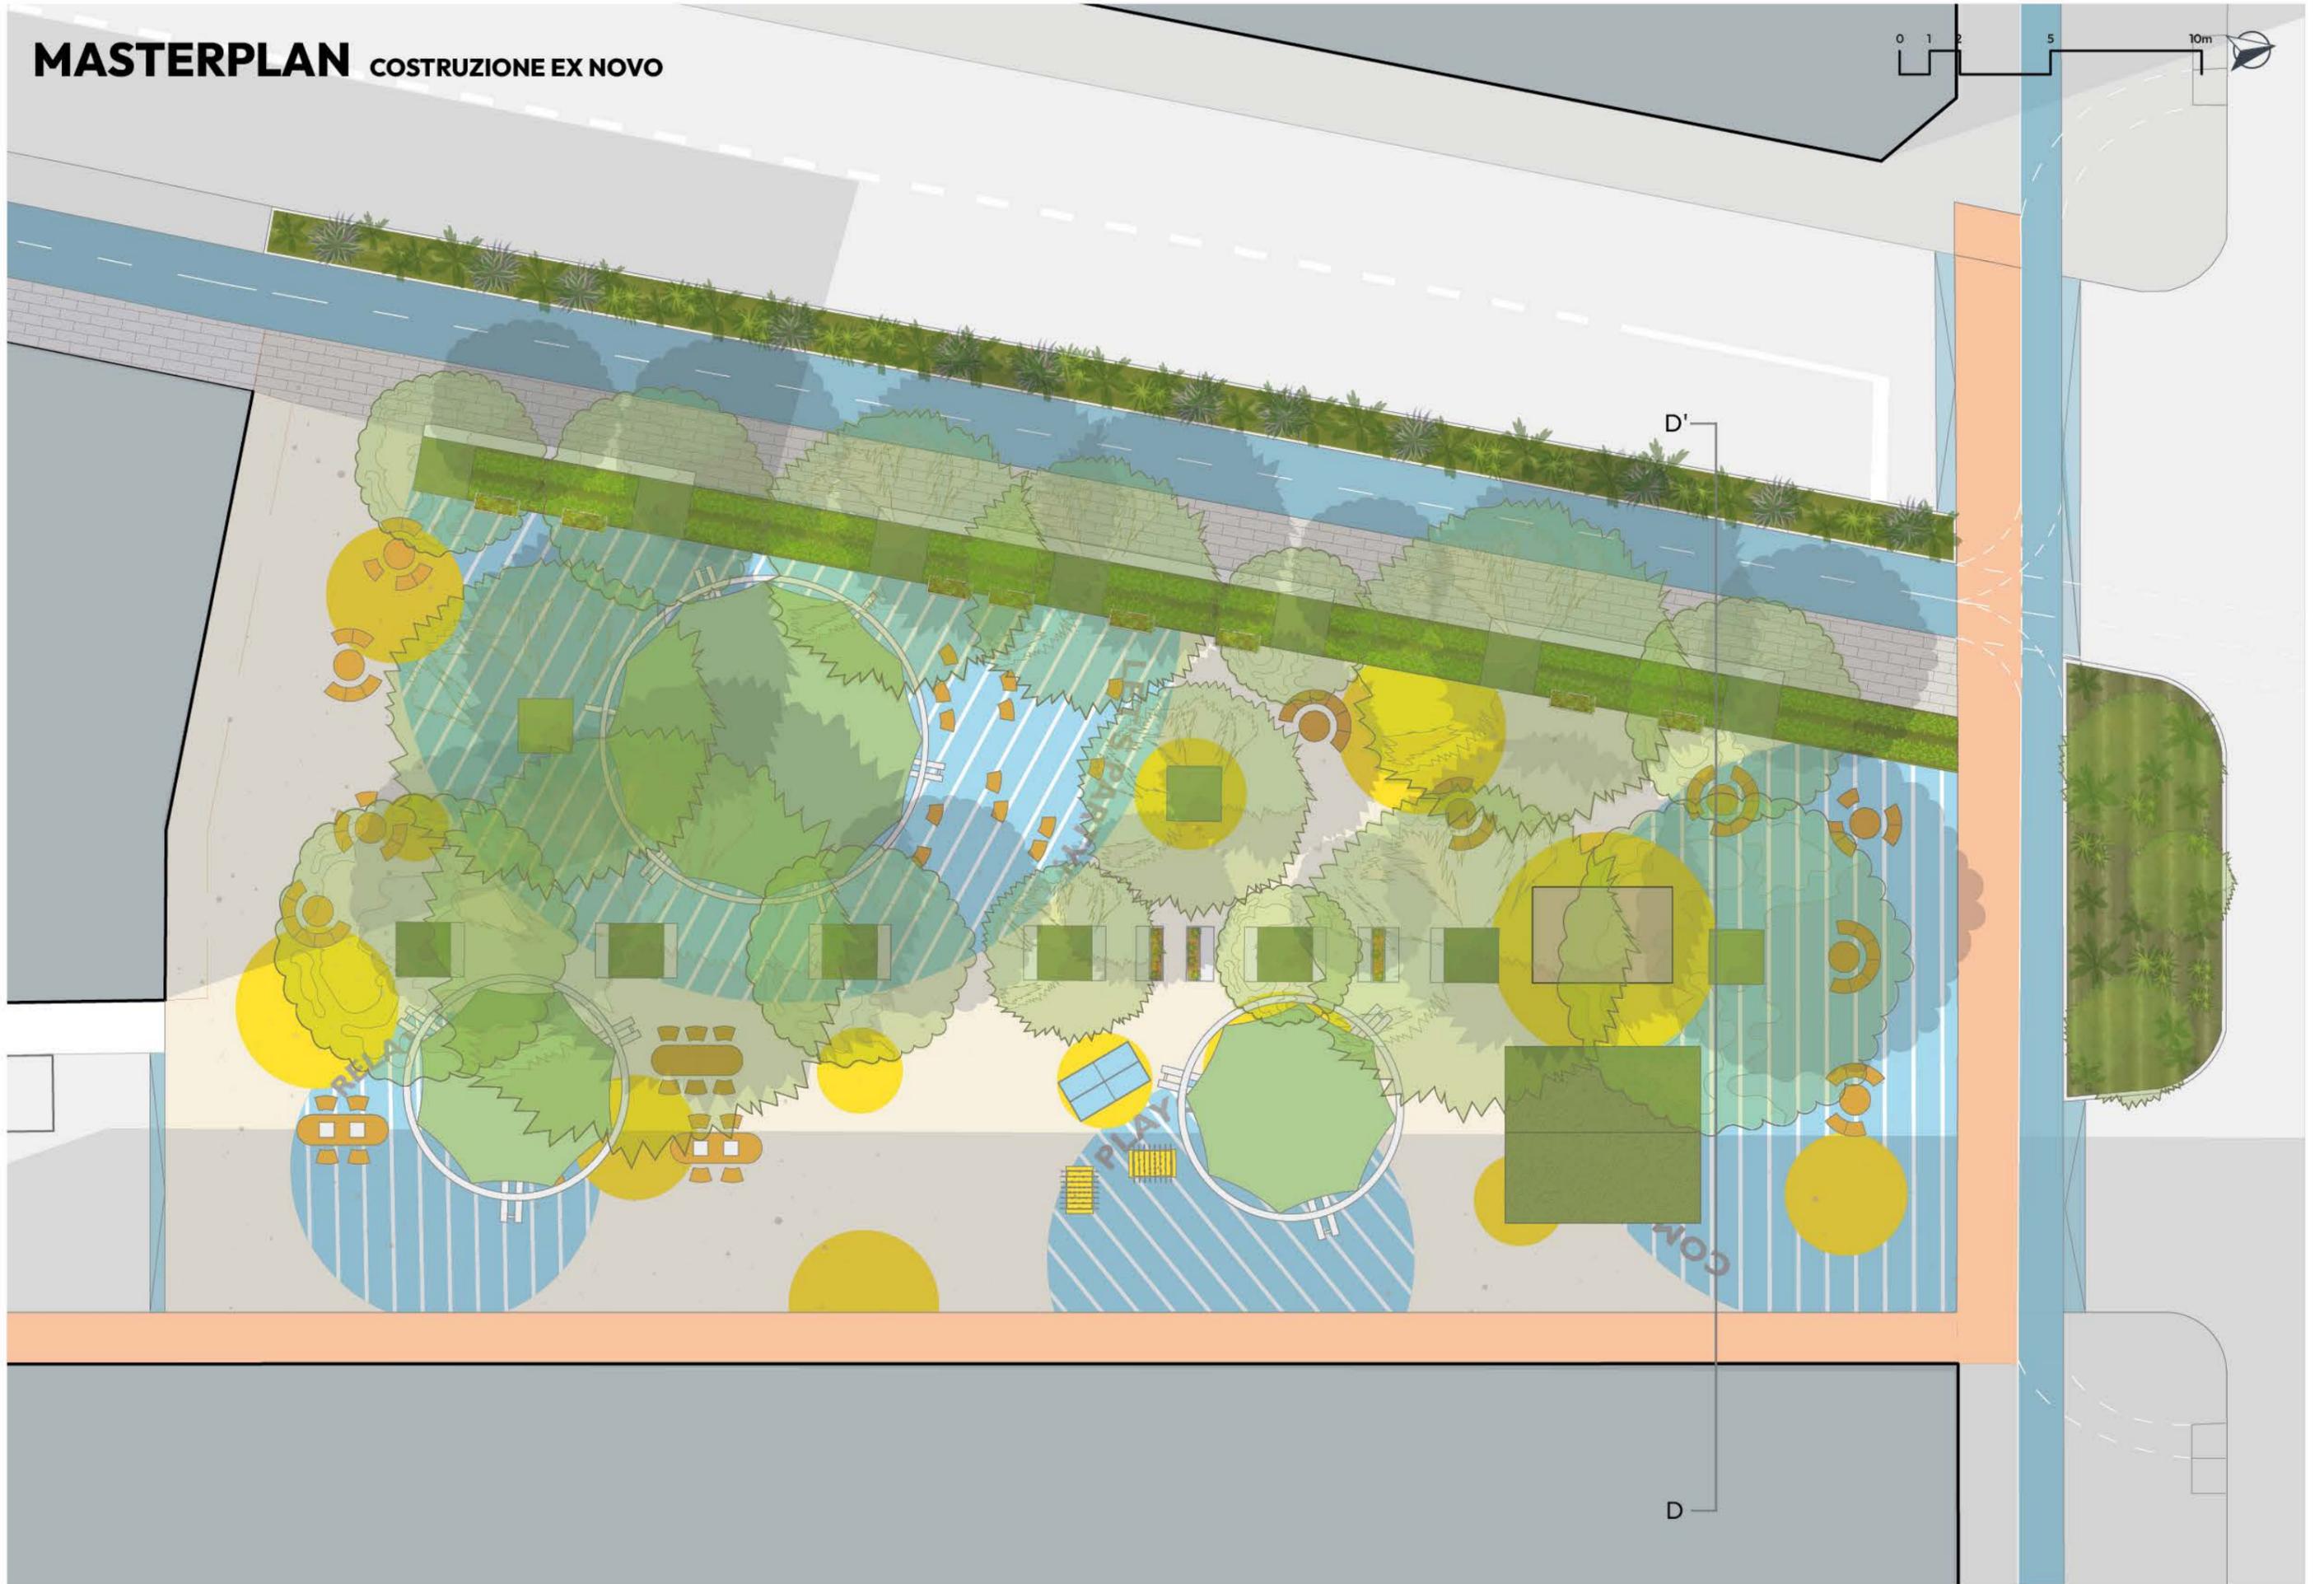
Planimetria della piazza con la nuova costruzione
